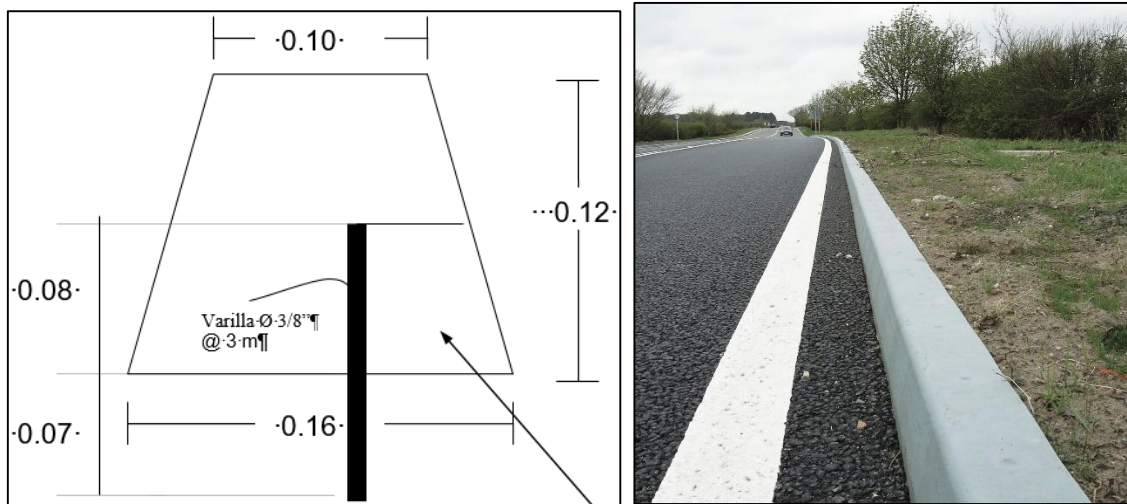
Diseño y dimensiones de bordillo a construir.
